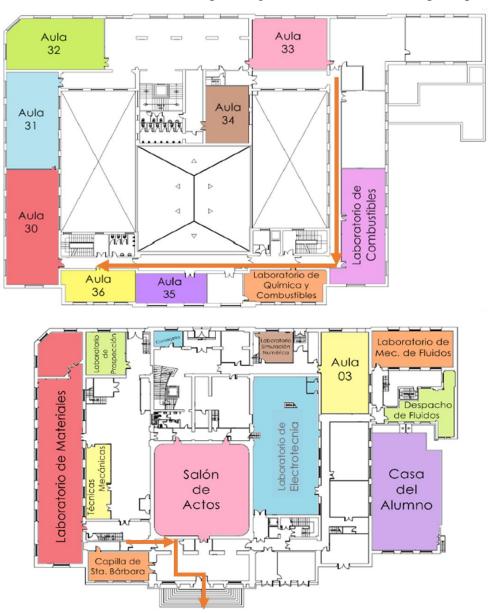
Plano general del tránsito para la salida del edificio M2 (3ª planta y baja, respectivamente).
